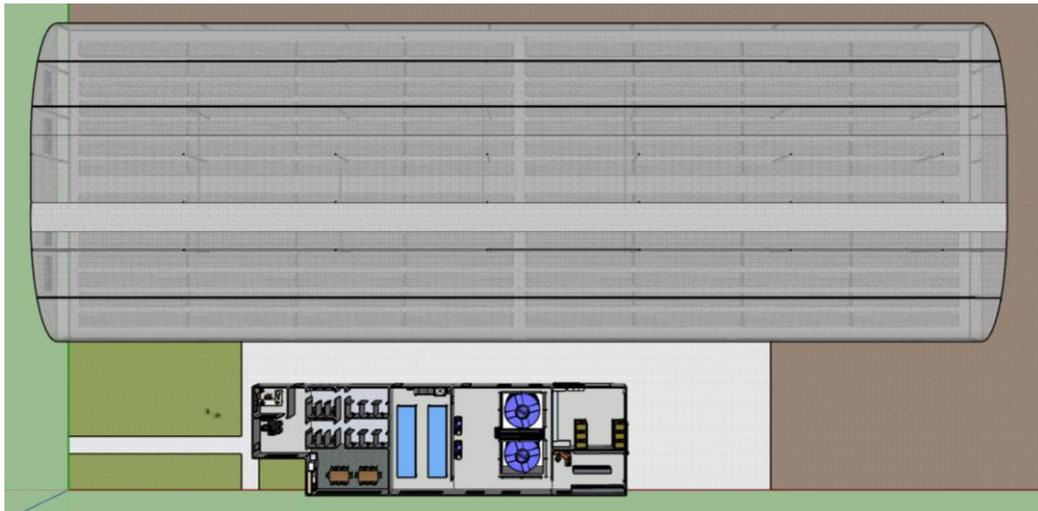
Lay out total de planta. Fuente: Elaboración propia.
